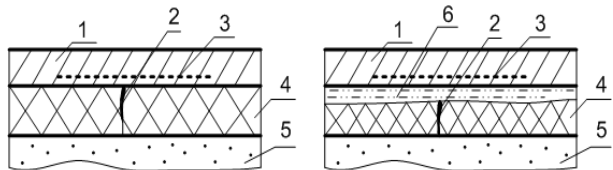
Схема усиления асфальтобетонного покрытия геосетками «Армдор»: 1 – слой усиления из асфальтобетона; 2 – трещина; 3 – геосетка «Армдор»; 4 – старое асфальтобетонное покрытие; 5 – основание; 6 – выравнивающий слой
